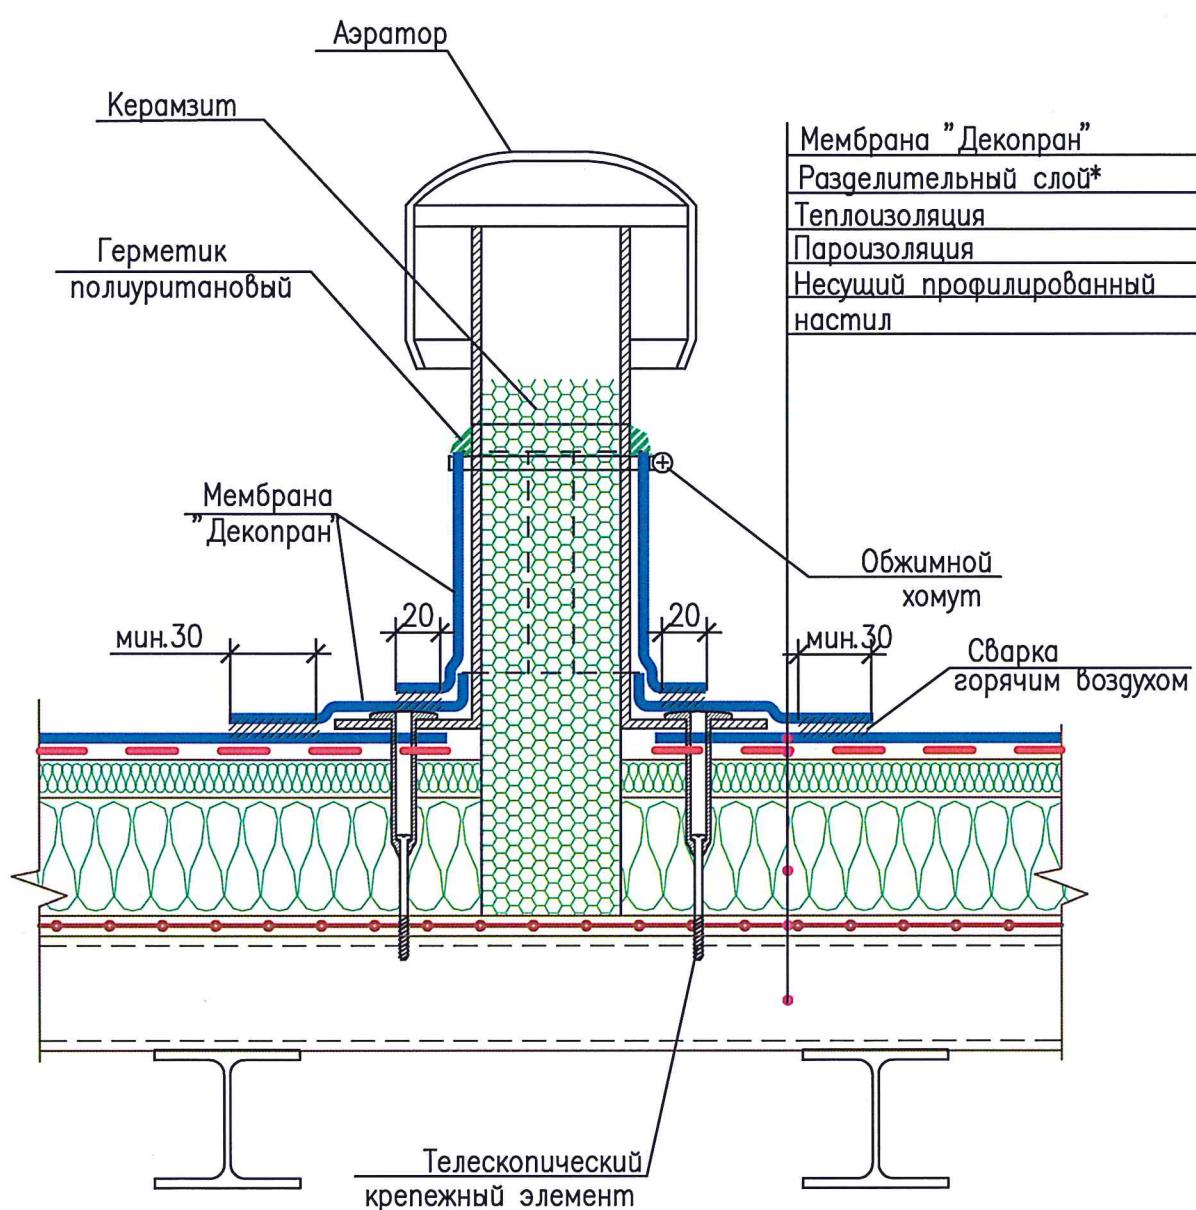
Конструктивные решения узлов для кровли с несущим профилированным настилом с механическим закреплением. Устройство примыкания к трубе
